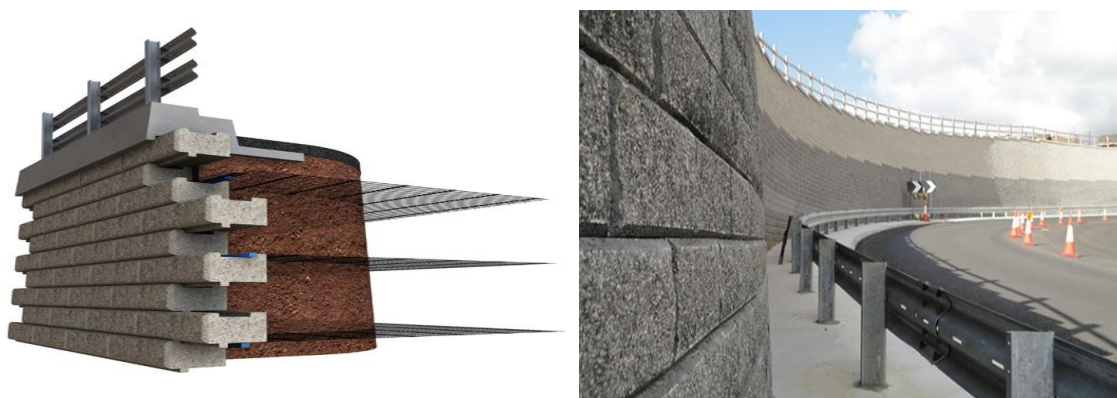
Подпорная стена армогрунтовой системы Тенсар TW1. на подходах к путепроводу
